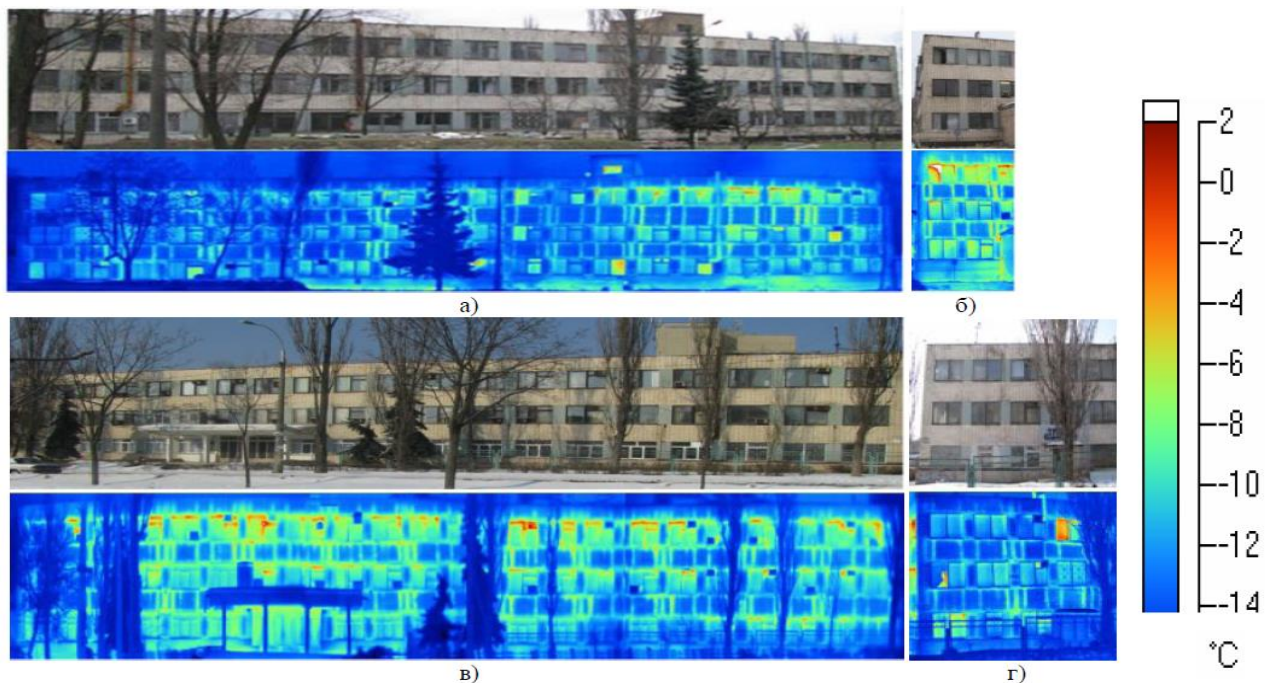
Тепловізійне обстеження зовнішніх поверхонь ОК будівлі: а) північний; б) західний; в) південний; г) східний фасади.
